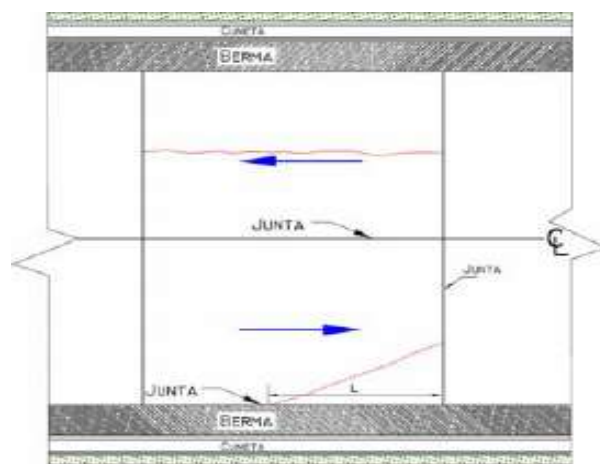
Vista en planta de grieta (GL) (INVIAS, 2006).
